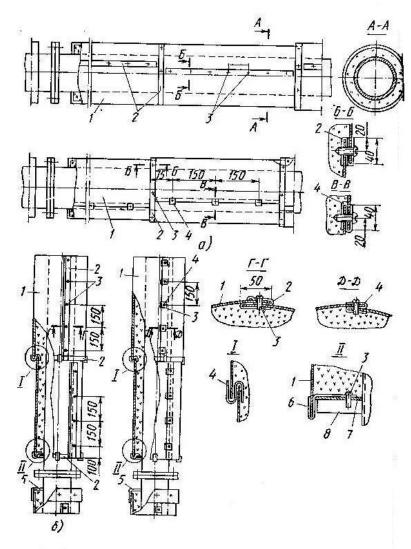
Покрытия изоляции упругими оболочками горизонтальны (а) и вертикальных (б) трубопроводов:
